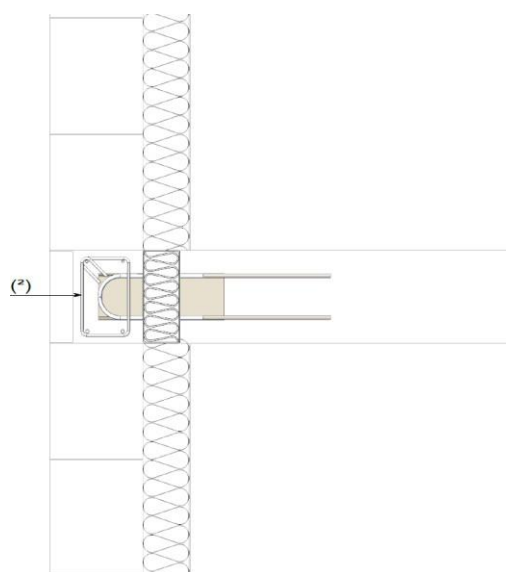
Disposition de chainage de mur en maçonnerie (vue en coupe)
